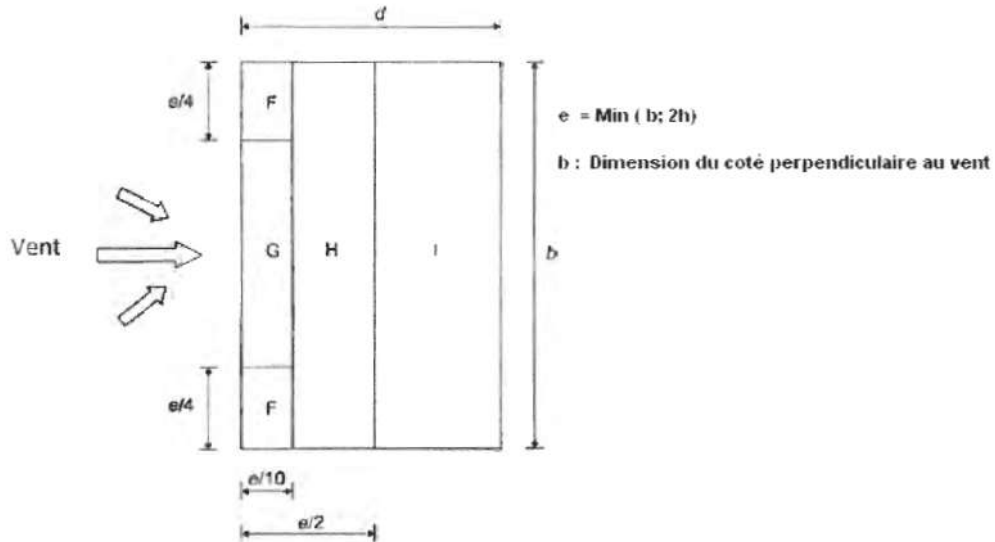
Vue en plan des zones de pression sur la toiture suivant le long pan.
